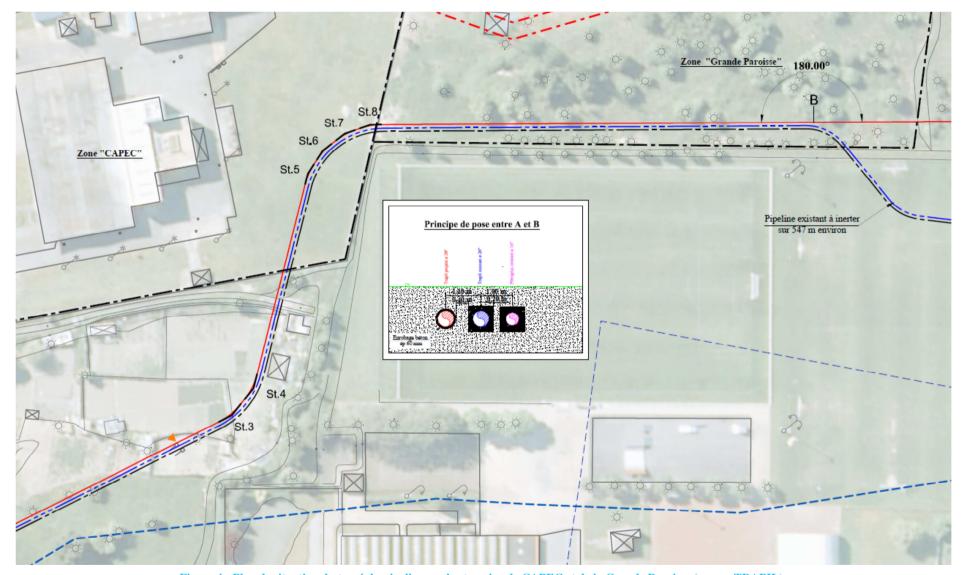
Plan de situation du tracé du pipeline sur les terrains de CAPEC et de la Grande Paroisse (source TRAPIL)
